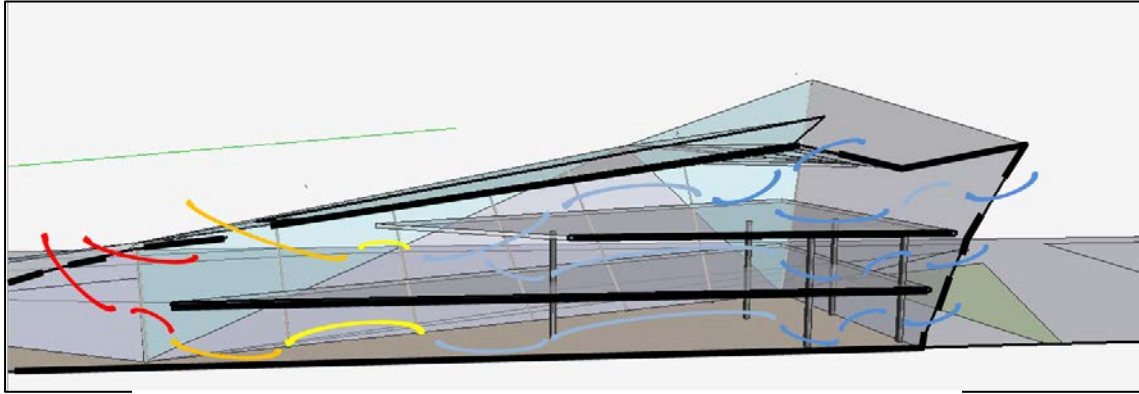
Coupe de l'unité commerciale montrant le cheminement de la ventilation traversant
